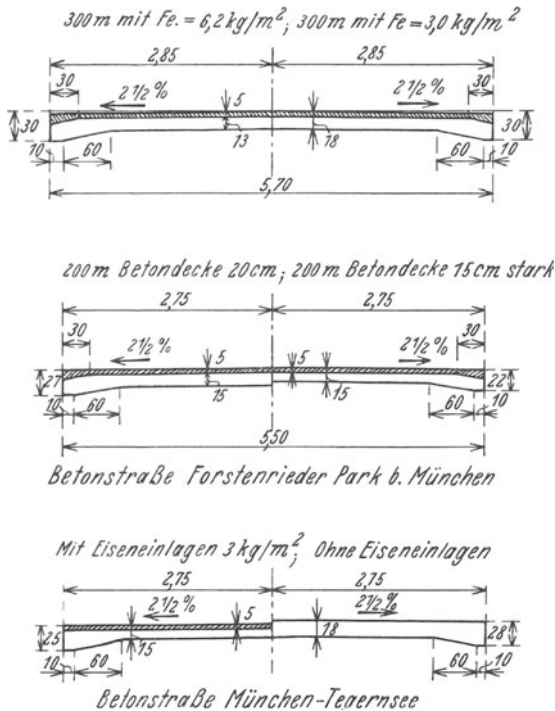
Querschnitte von Betondecken in Deutschland und in der Schweiz.
